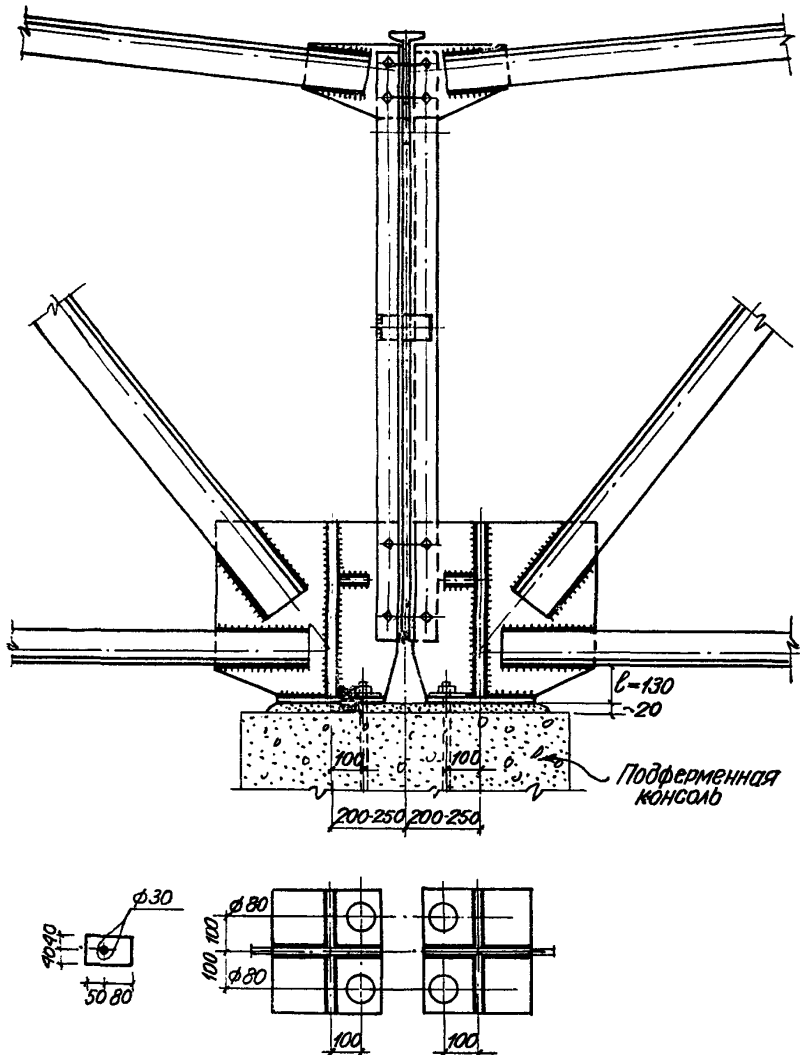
Опираие стропильных ферм на железобетонные колонны, унифицированное для крайней и средней опоры
